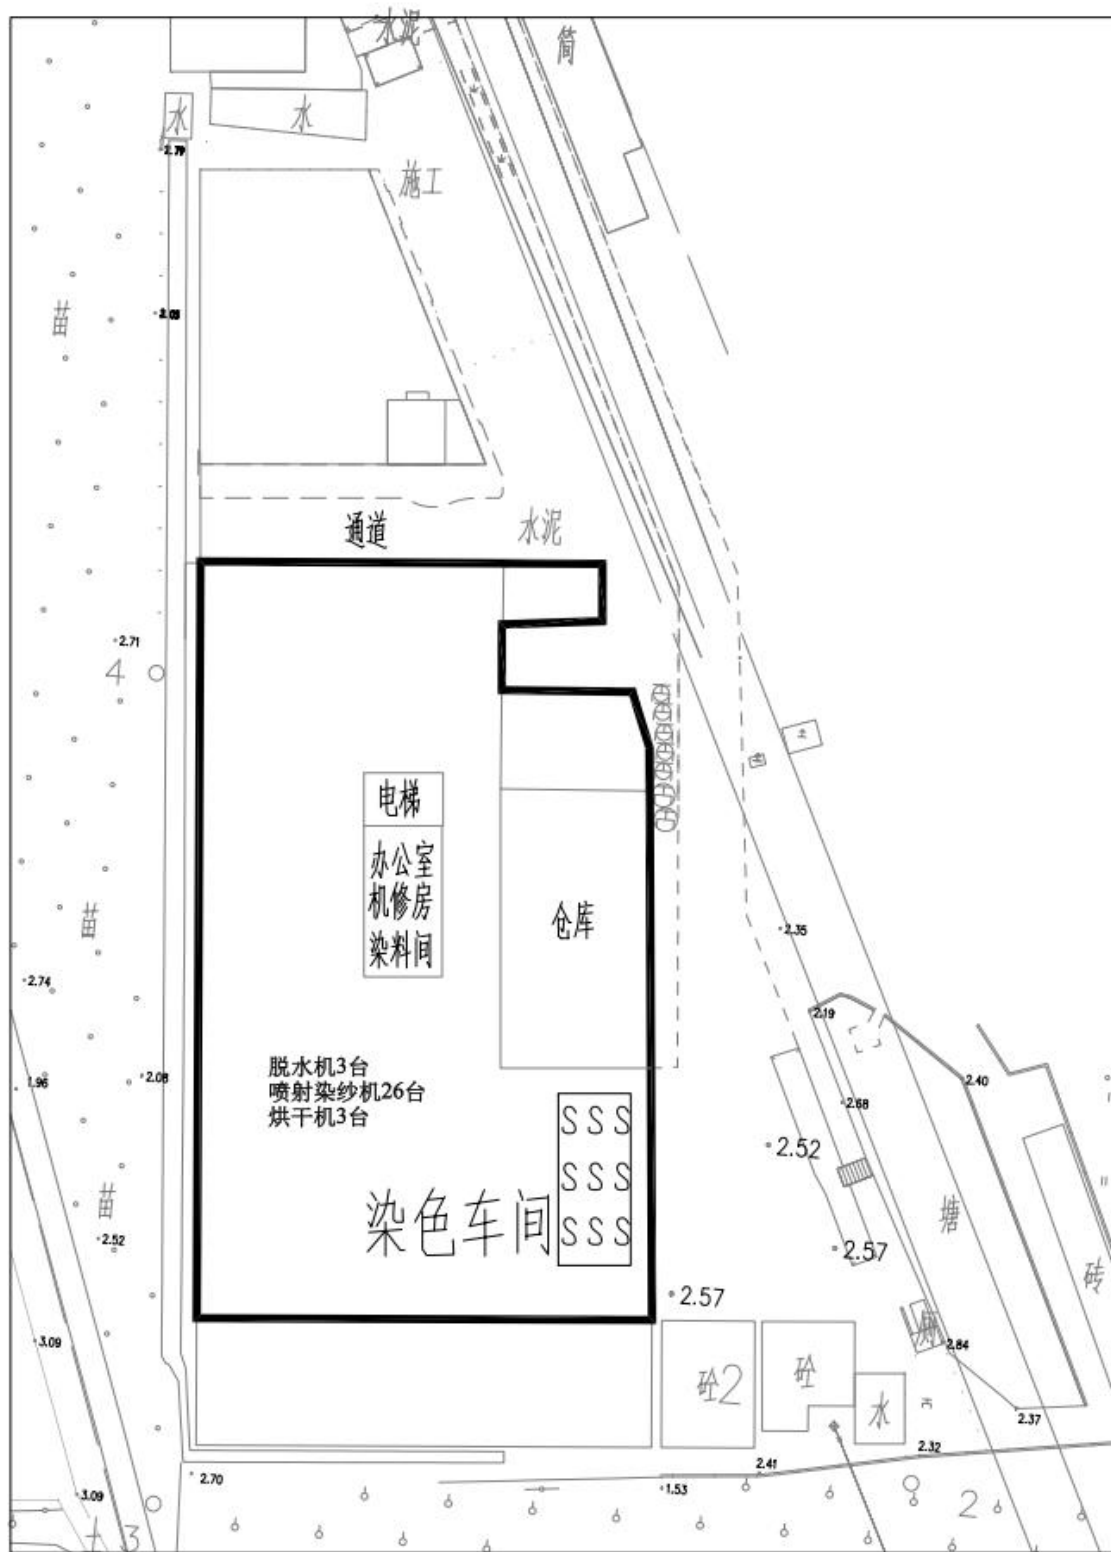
项目一层平面布置图-1（比例尺 1： 600）
